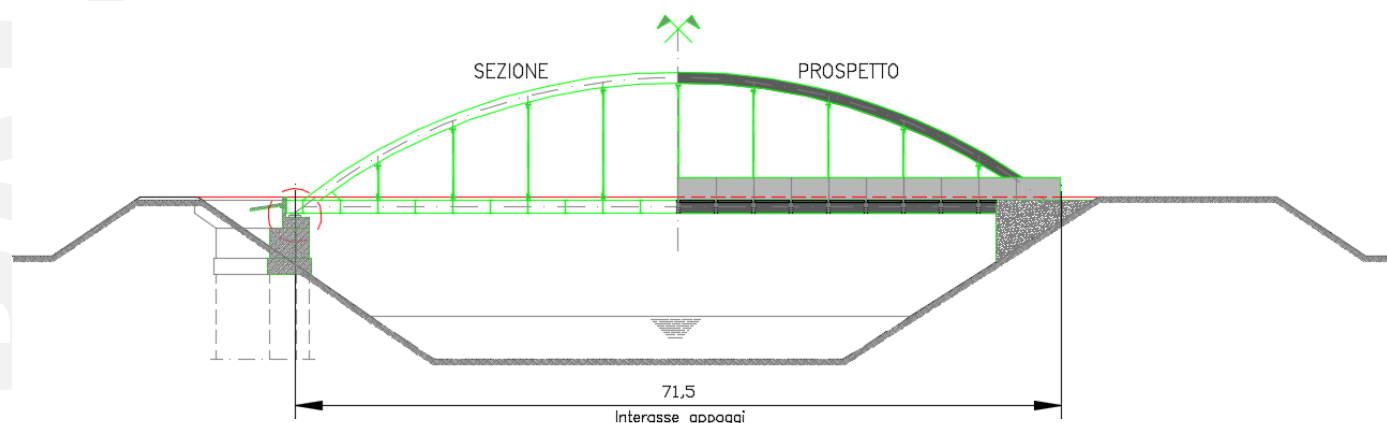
Nuovo ponte sul canale Scaricatore – Progetto Preliminare
